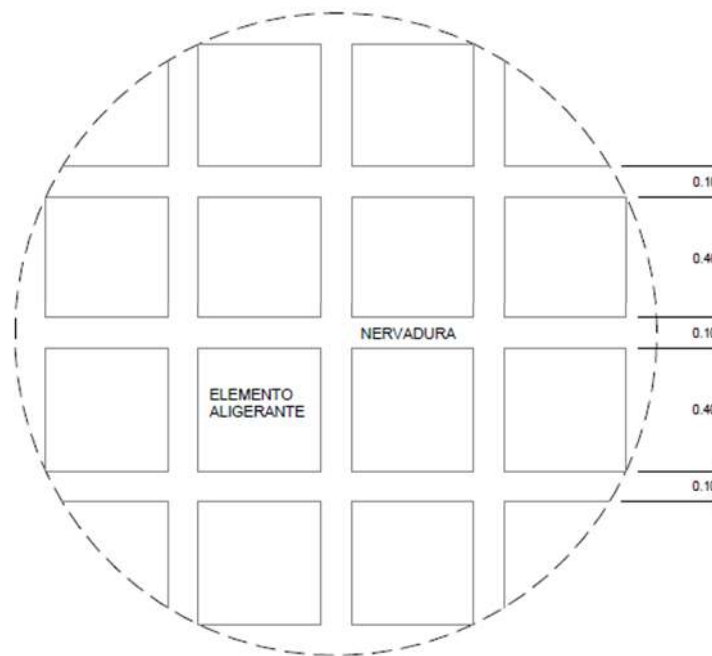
Detalle de disposición de casetonesl. - Fuente: Elaboración propia
